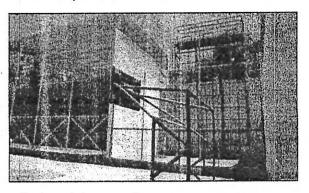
y 20.- Se observa humedad y grietas en el muro
